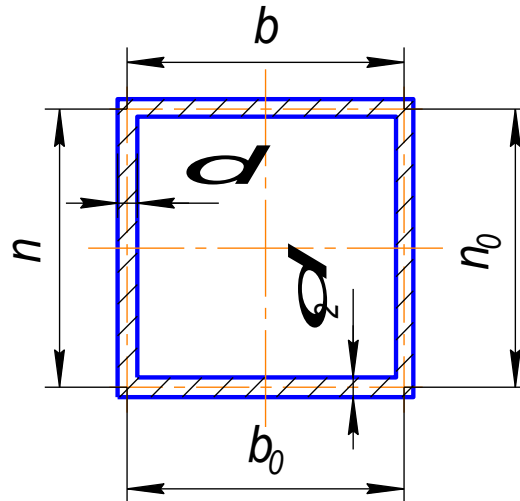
Розрахункова схема балки (поперечний переріз)
